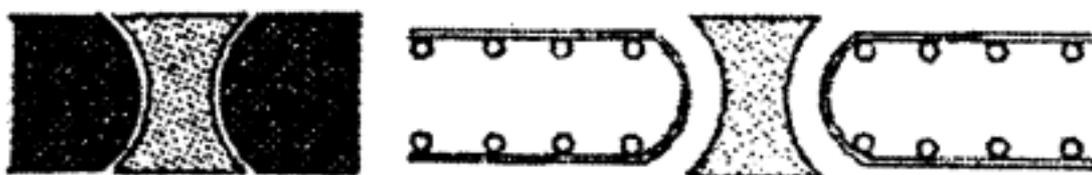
Junta pilote, armado tipo ( Vicente Ordura Vidal, 2015)
